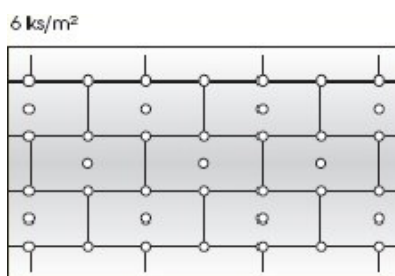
Montáž hmoždinek Ejot H1 eco
